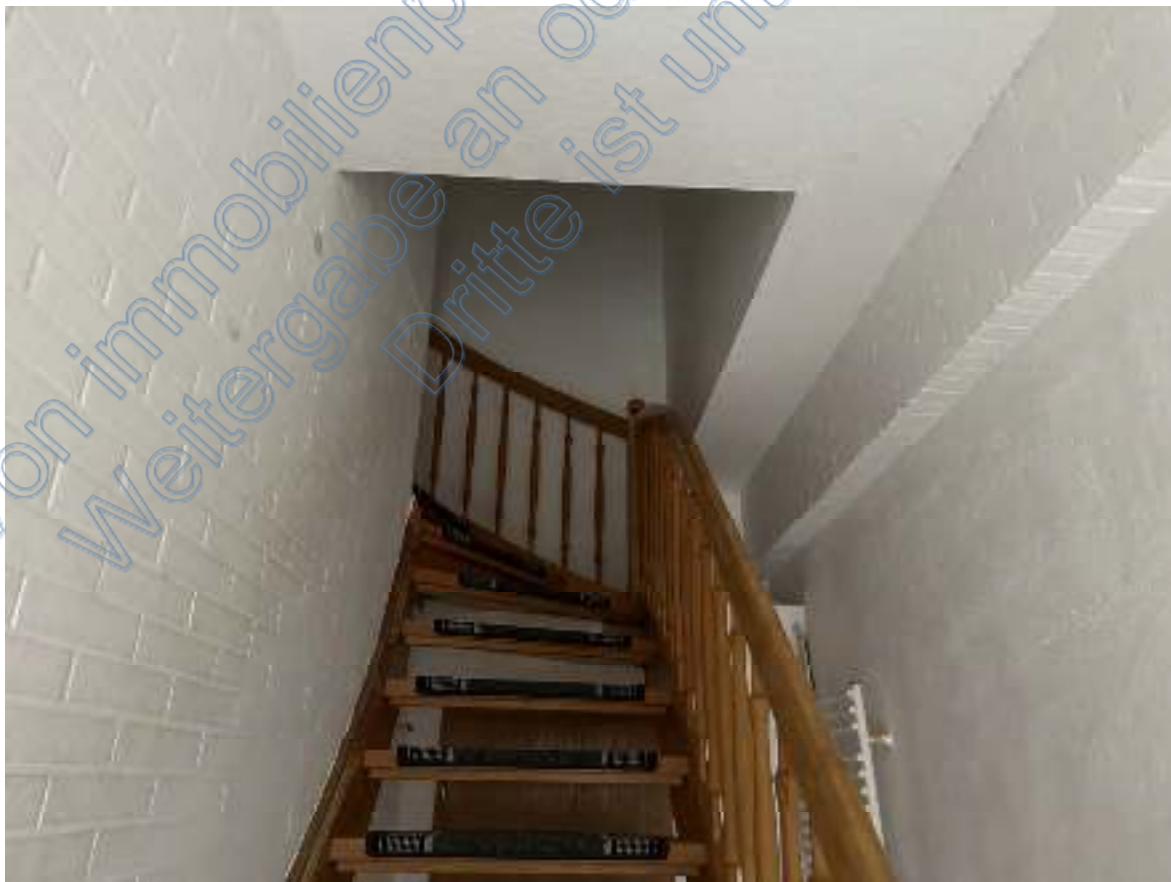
Ausschnitt – Treppe Richtung Flur im Obergeschoss
